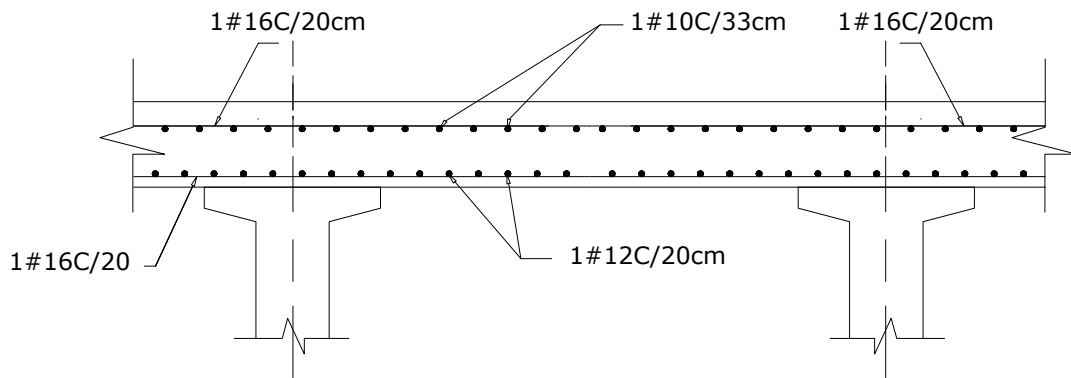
Esquema de armado Refuerzo de acero en la losa interior
